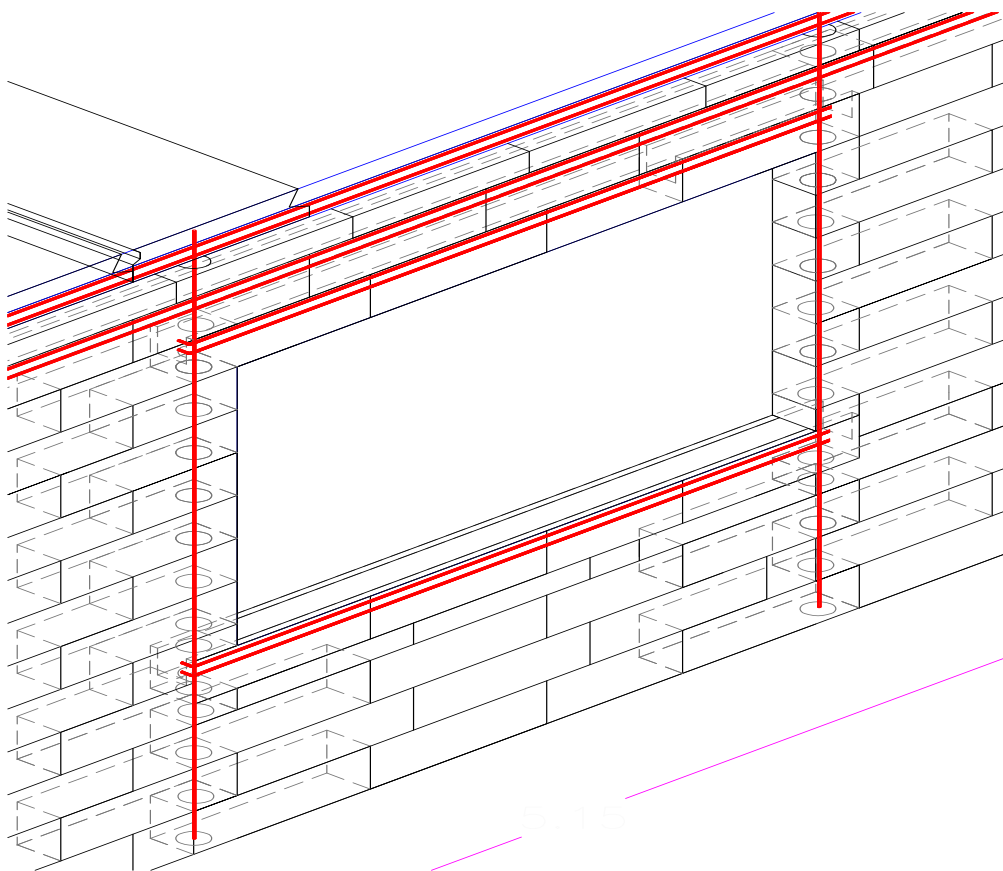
Detalle del block tipo “U”, como refuerzo horizontal, para cargas por flexión y por gravedad.
